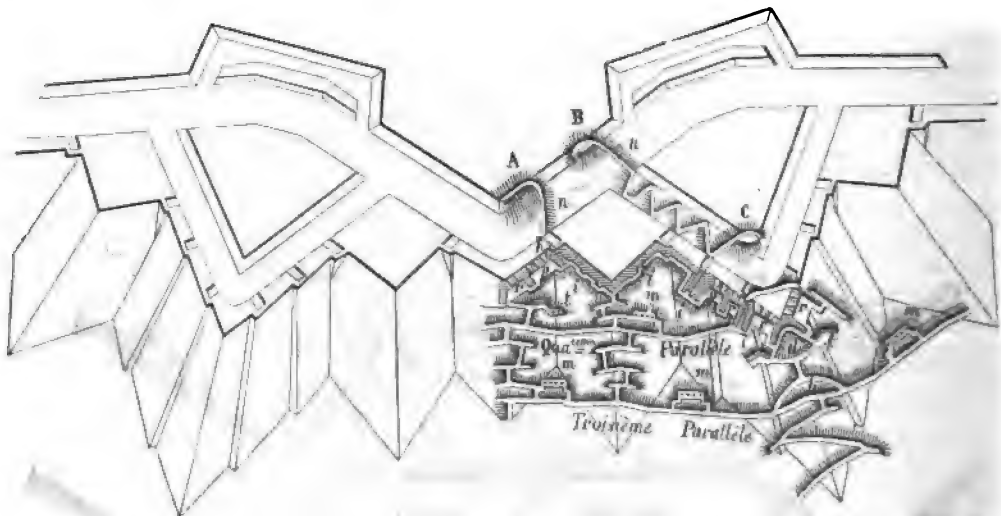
Travaux de Siège. — Préliminaires de l'assaut.
